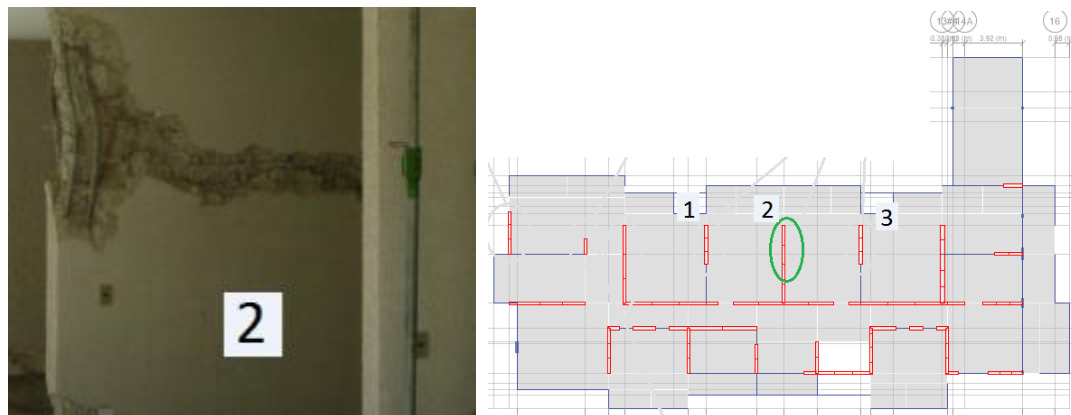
Imagen del daño y ubicación en planta del elemento T13-2
